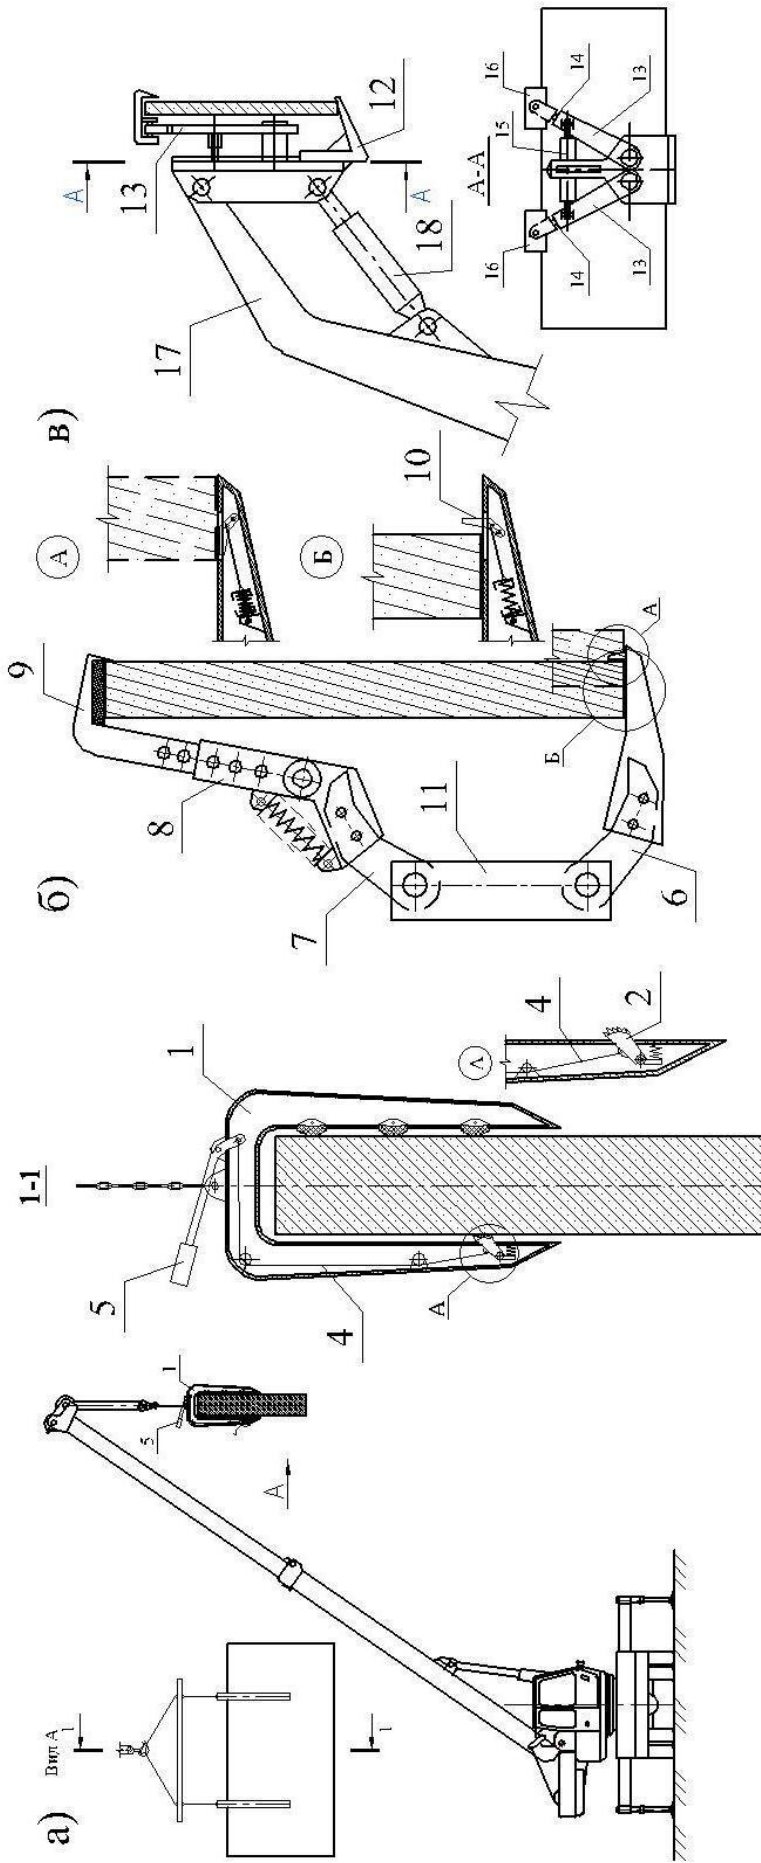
Конструктивні рішення робочого обладнання для монтажу (демонтажу) будівельних конструкцій в умовах реконструкції будівель та споруд:
